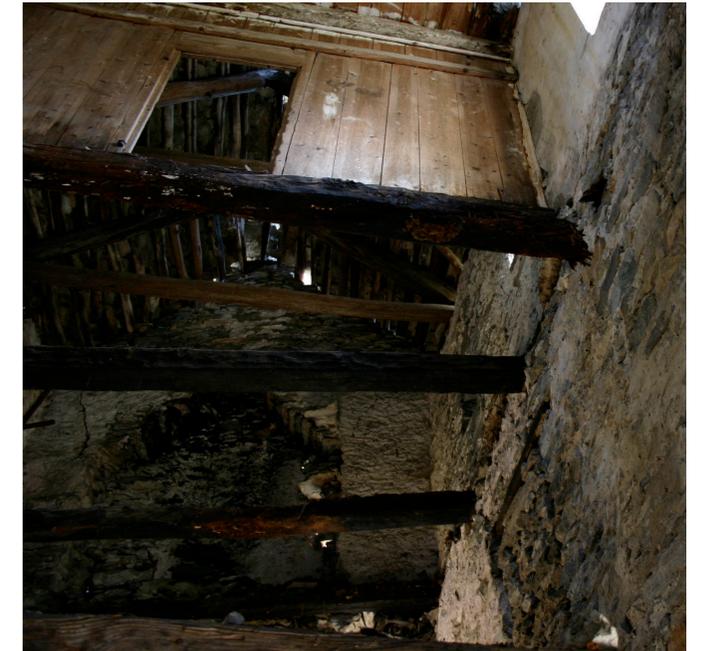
Foto pre-interventi dell'interno dell'edificio. Si nota al secondo piano il vano del caminetto successivamente abbattuto. (Foto di Maurizio Cesprini)
